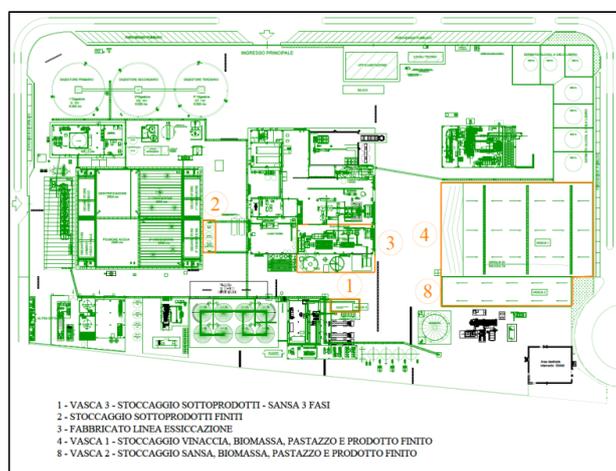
planimetria della sezione ESSICCAZIONE SOTTOPRODOTTI
